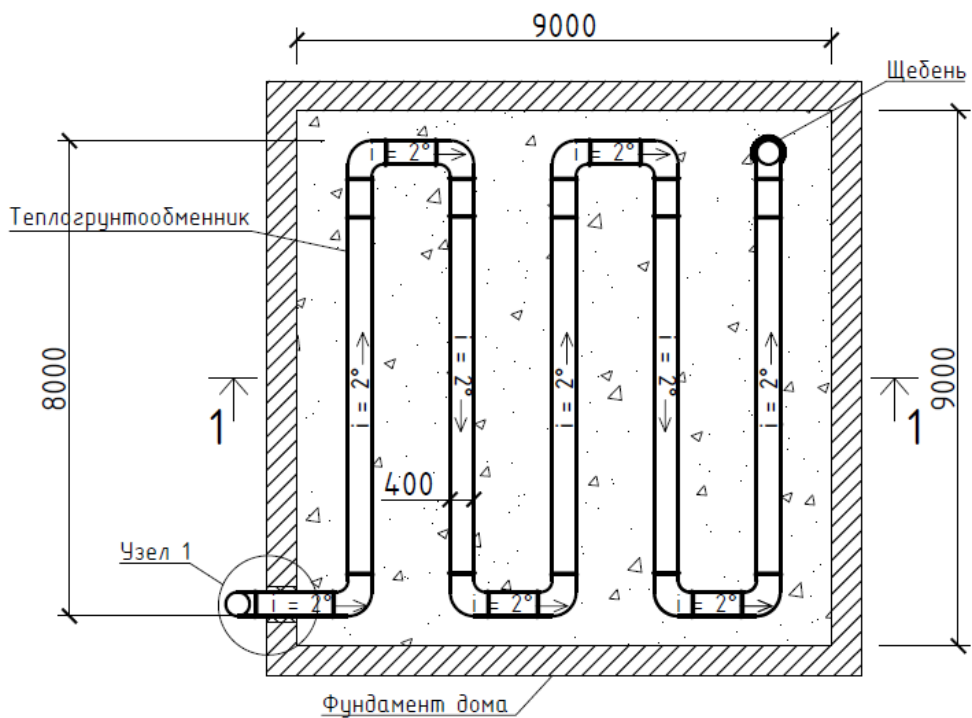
Вариант устройства канального (трубного) теплообменника совместно с фундаментом здания
